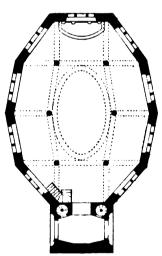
Benet's Fink church zu London. Grundriss.
